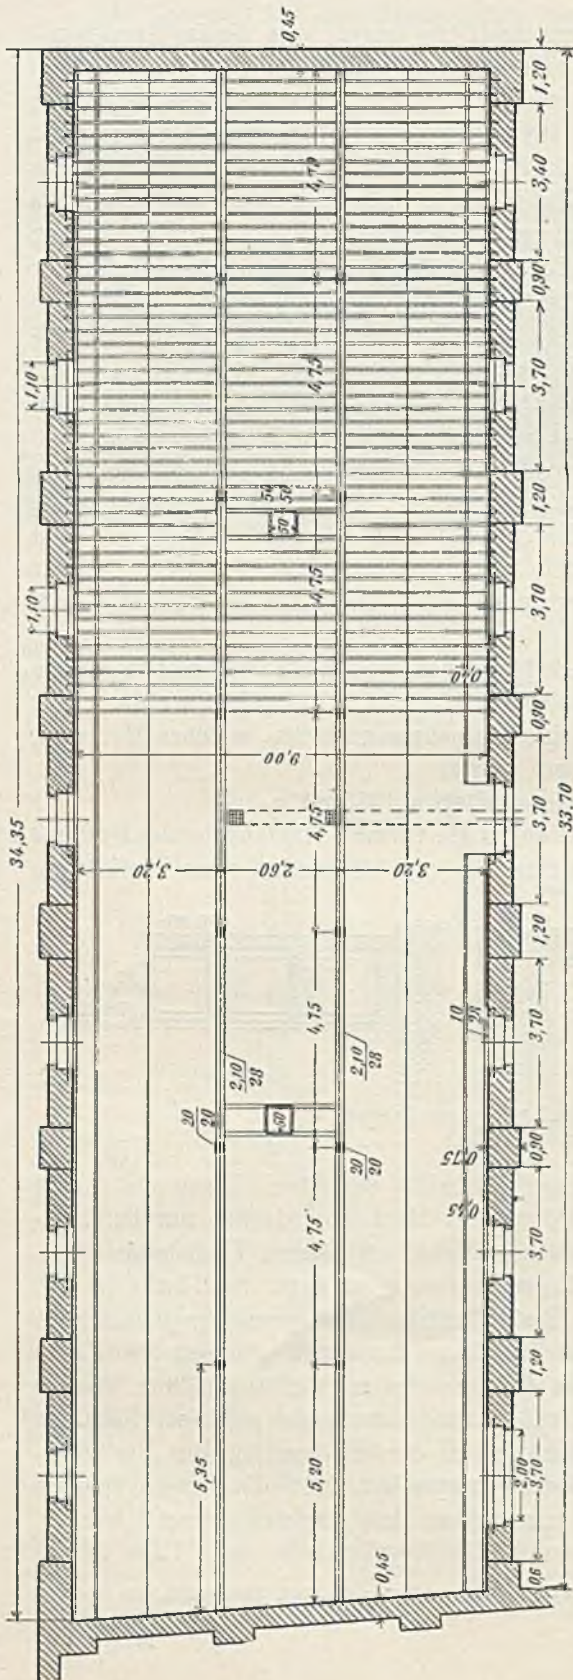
Stallgebäude der Moserschen Gutsverwaltung, Achau. Grundriß.
